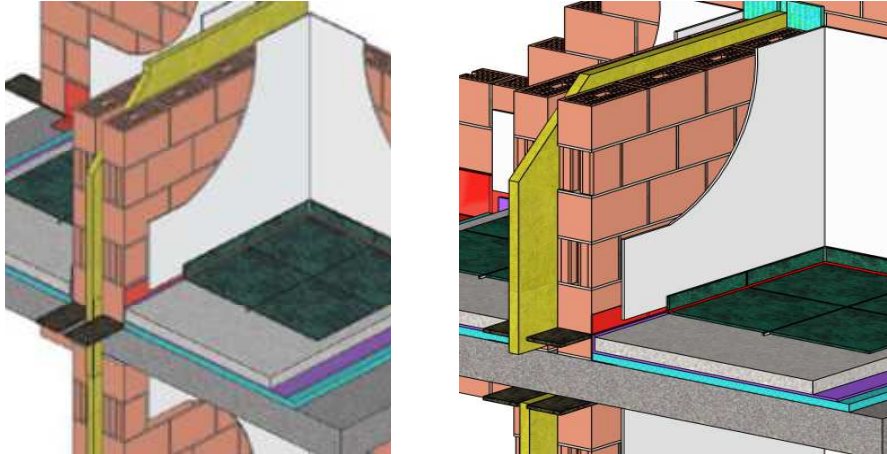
Tipiche pareti in elementi di laterizio realizzate in Belgio per separare alloggi distinti; a sinistra soluzione raccomandata per case a schiera con solaio interrotto nel giunto; a destra soluzione con solaio continuo - Typical brick Belgian partitions between dwellings; Left, solution for row houses, with interrupted floor; on the right the solution with not interrupted floor slab [7]
